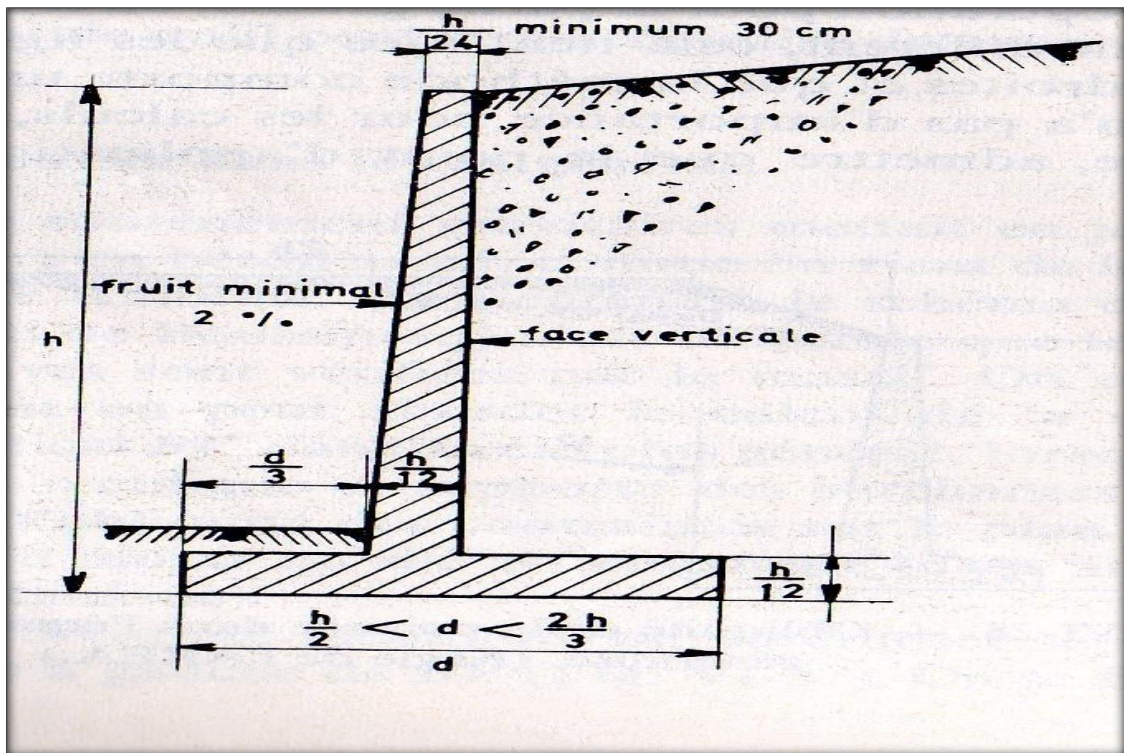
Dimensions usuelles d'un mur de soutènement en Béton armé.
